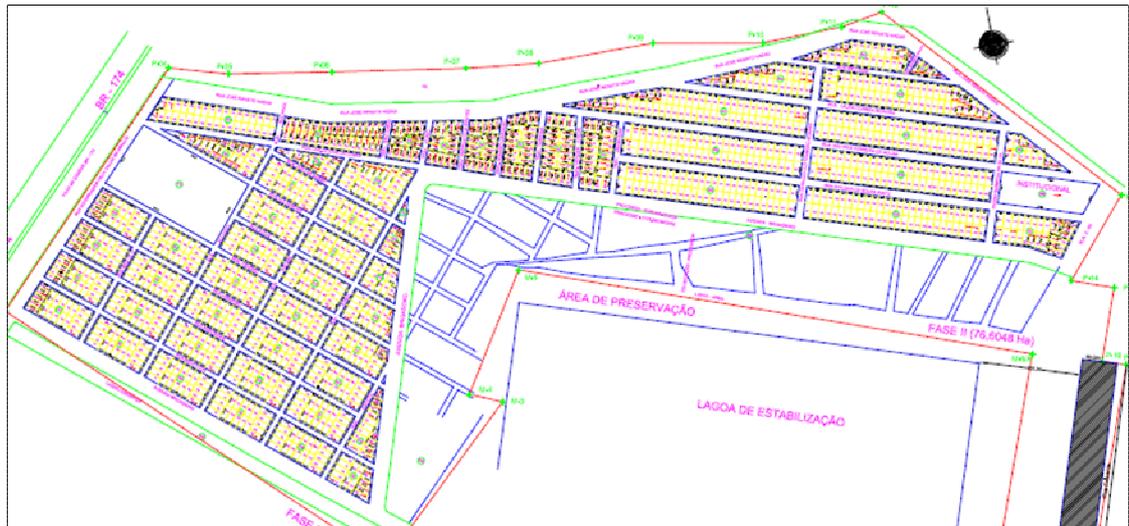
Planta do loteamento enviada para aprovação, 2007
